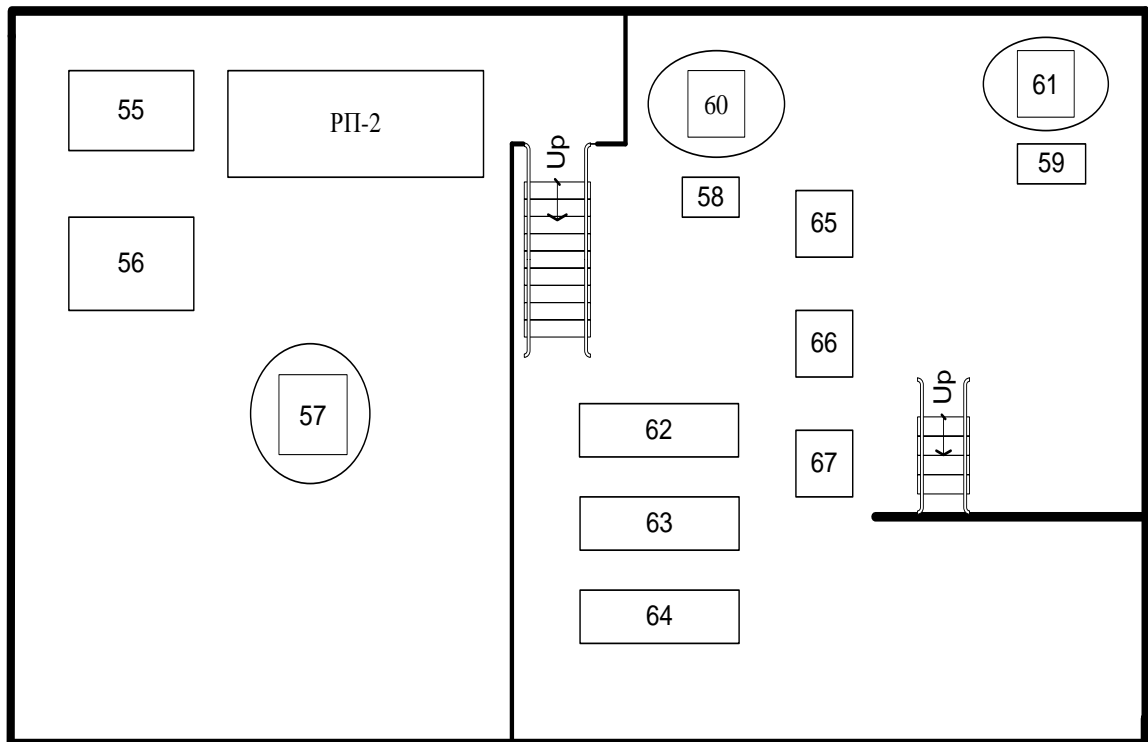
План 2-го этажа фильтровально-сушильного отделения.
